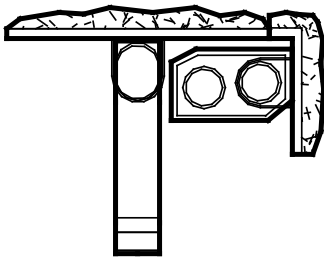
Grundriss Eckstein mit Eckanker
